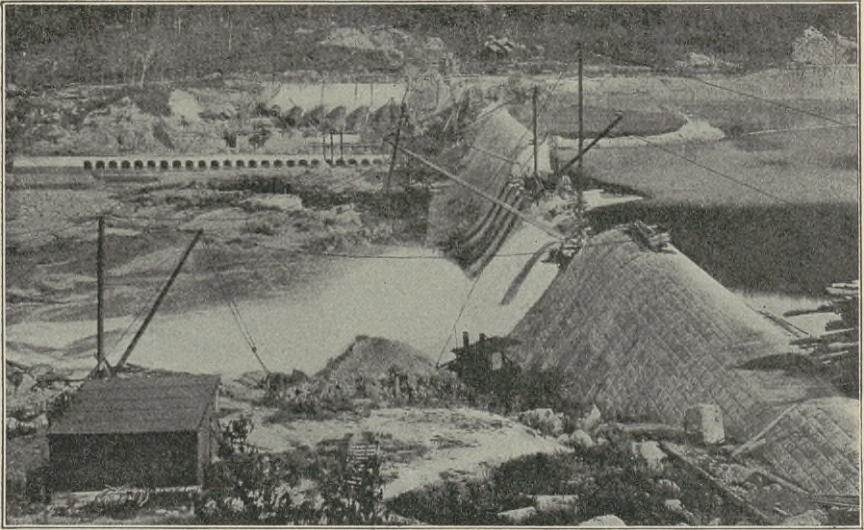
Wasserkraftwerk zu Spiers Fall (Amerika).
